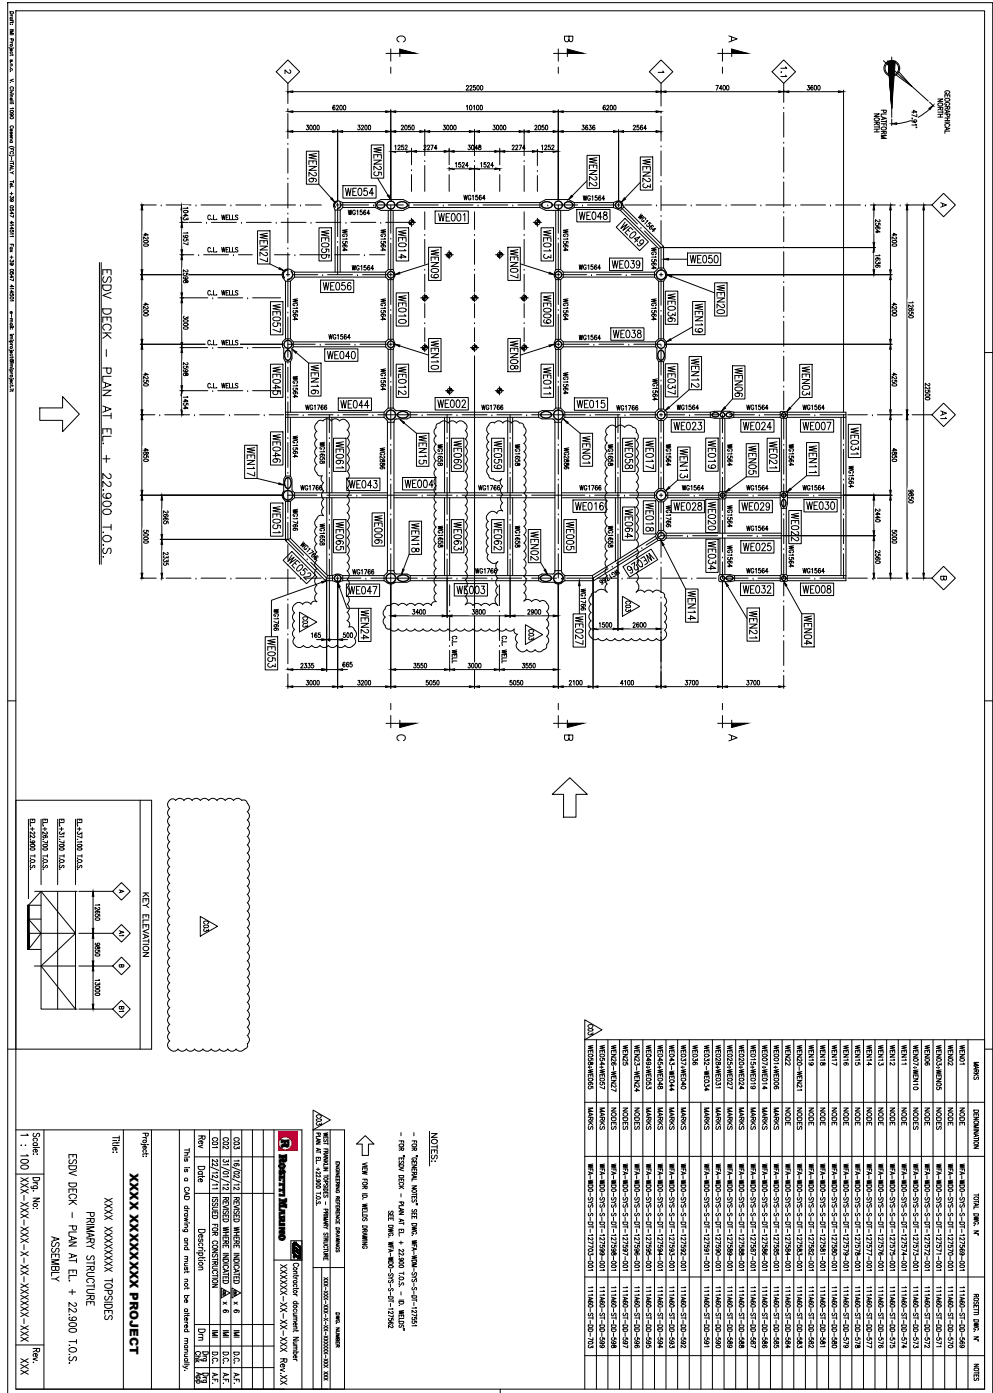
ESDV level deck - Shop drawing - Plan view - Primary structure
